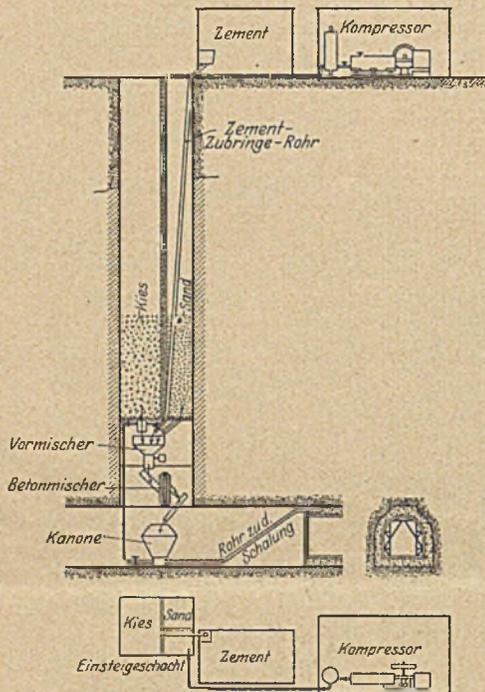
Betonieren mit Druckluft beim Tunnelbau. Schematische Baustelleneinrichtung beim Ohio-Montrose-Entwässerungstunnel.
